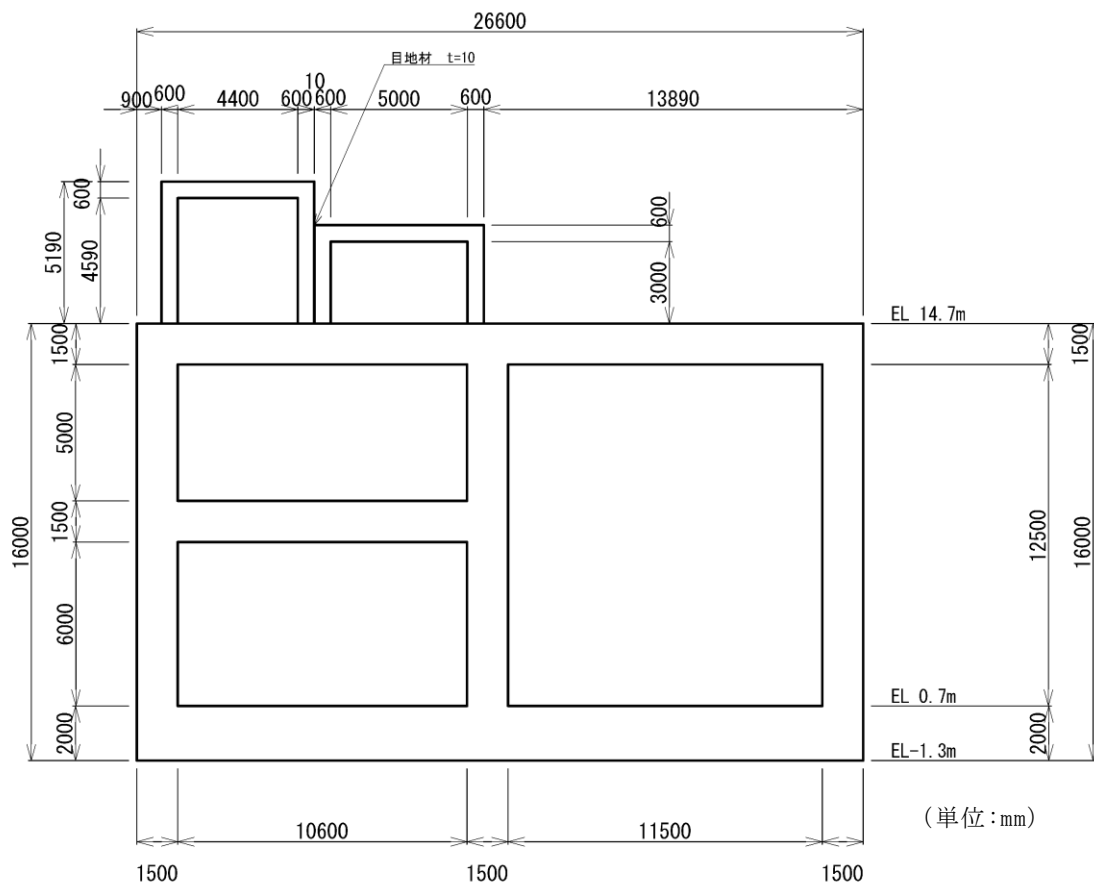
低圧原子炉代替注水ポンプ格納槽 断面図 (A-A 断面)
